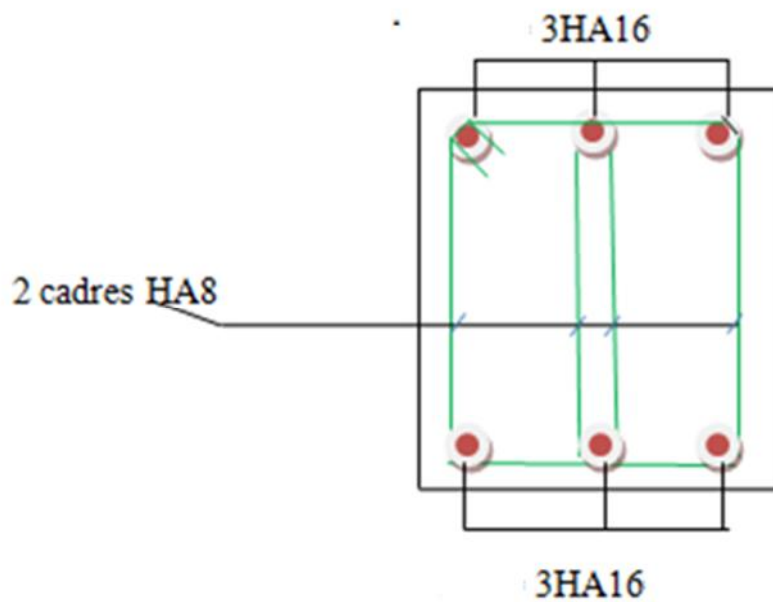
Coupe vertical en travée des poutres non adhéres aux voiles
